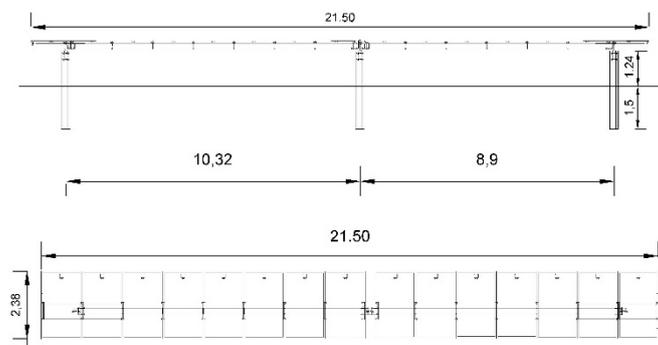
Prospecto frontale e vista in pianta delle strutture (15 moduli) ad inclinazione 0°
